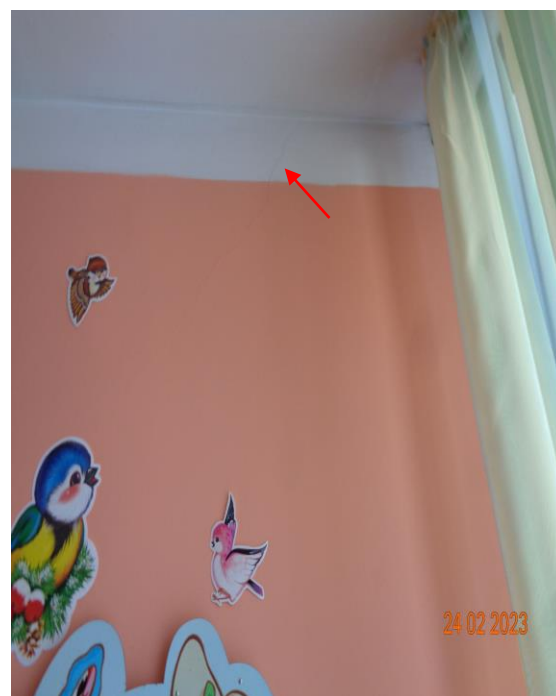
2 этаж. Оси В/1. Трещина с раскрытием до 0,2 мм.
